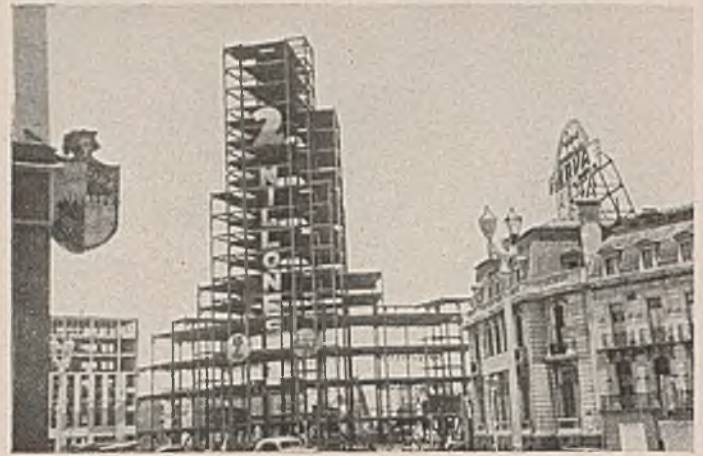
Hochhaus der Staatslotterie in Mexiko im Bau.
